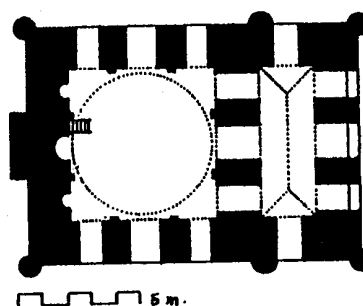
مسقط أفقي للجامع الجديد (يني جامع)
